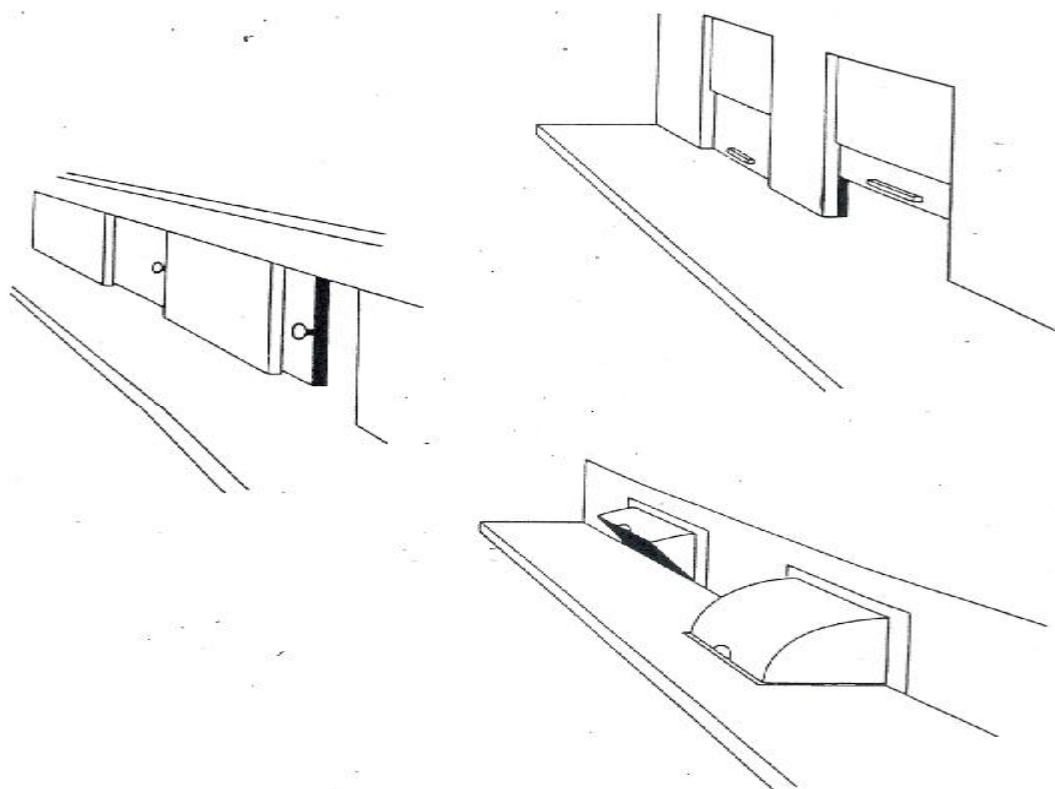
Plán zkušebních kójí a servírovacího stolu oddělených stěnou [29]
